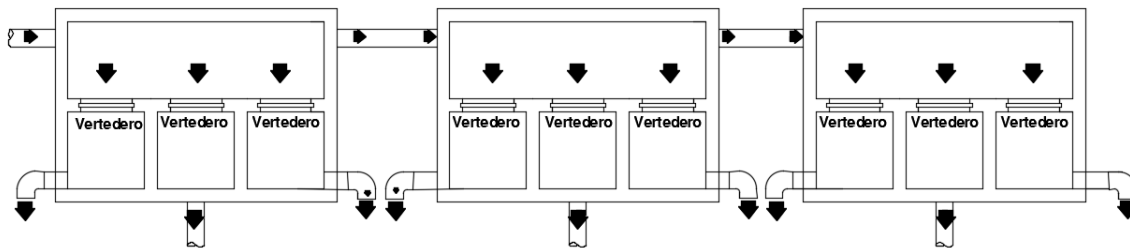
Vista en planta cajas separadoras de caudal de la planta N°14, contiene tres vertederos cada una. Basado en Moscoso (2006).
